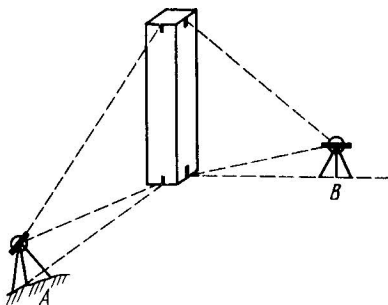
Схема установки колонн в вертикальное положение способом наклонного проектирования
